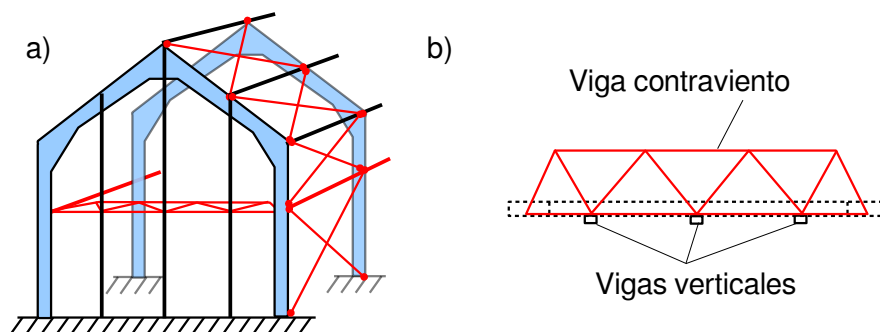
Viga contraviento en el pórtico de fachada, ejecutada como viga en celosía. a) Vista general. b) Vista en planta.
